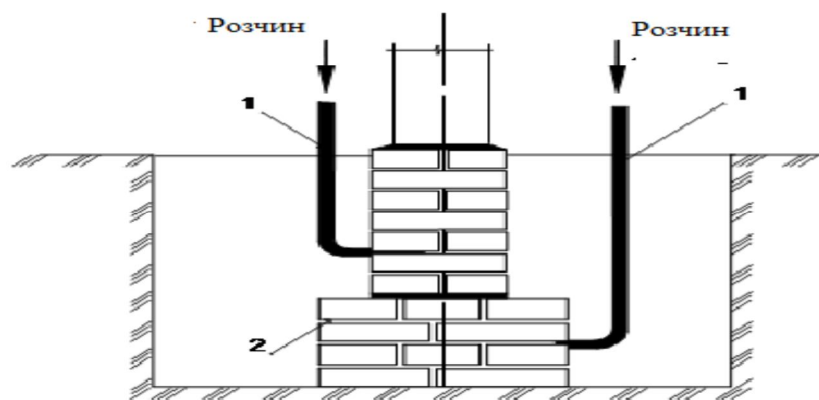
Зміцнення кладки старого фундаменту:
